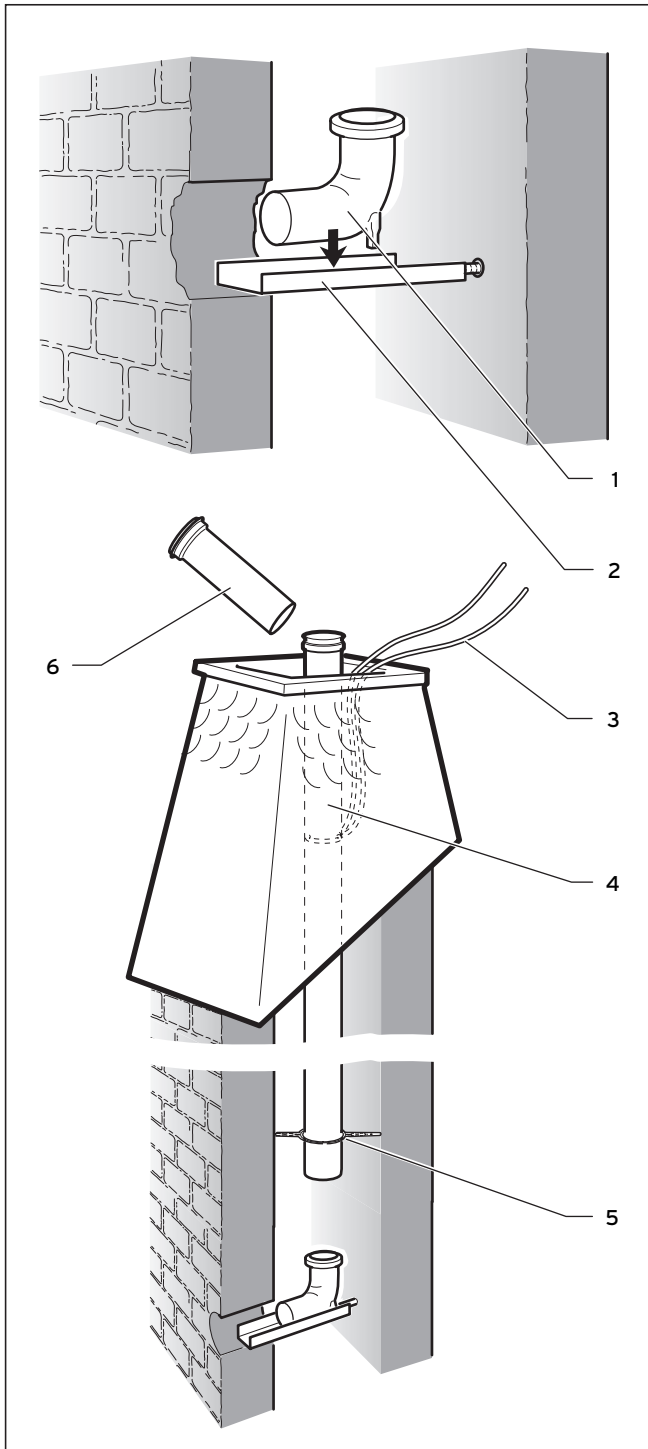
Montage de la barre d'appui et du coude-support, installation des conduits des fumées dans la cheminée
